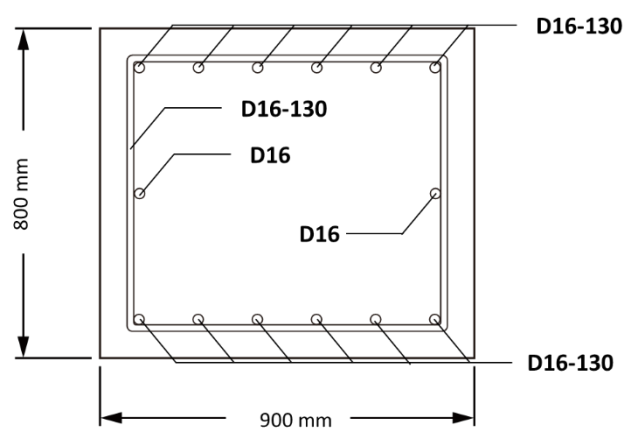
Detail tulangan potongan pilecap biasa dermaga arah melintang
